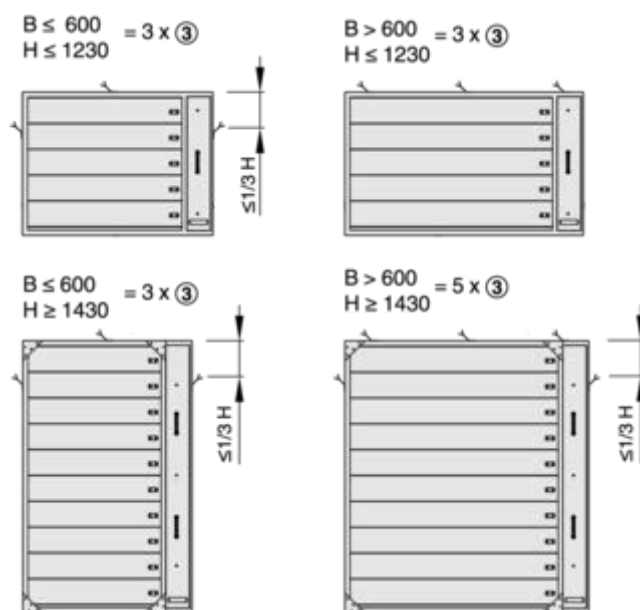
Posizionamento della linguetta di fissaggio EK-JZ
